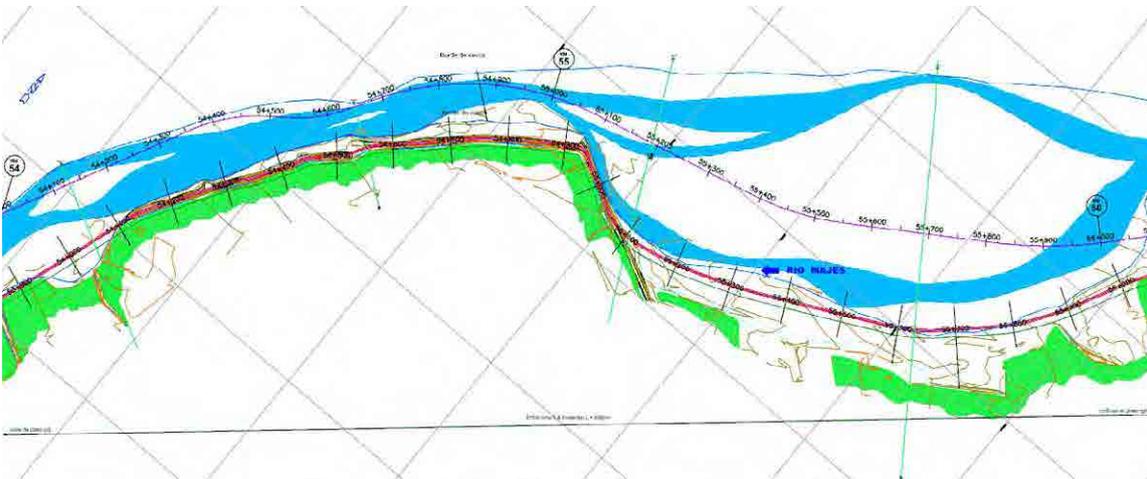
Planta de instalaciones Majes-5 (3)
